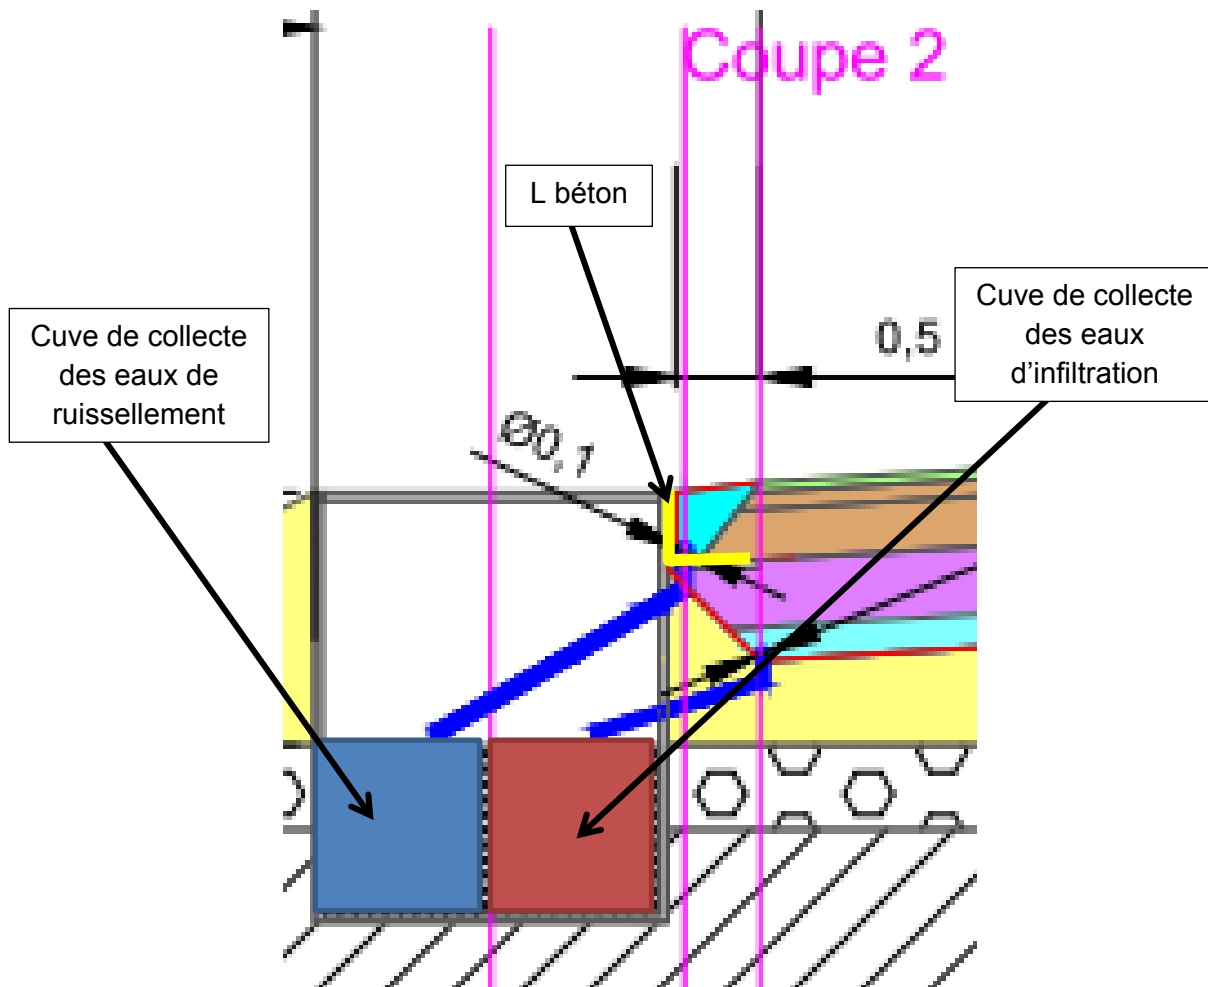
Vue de principe du système de collecte et séparation des eaux de ruissellement et d'infiltration en point bas des planches d'essais
